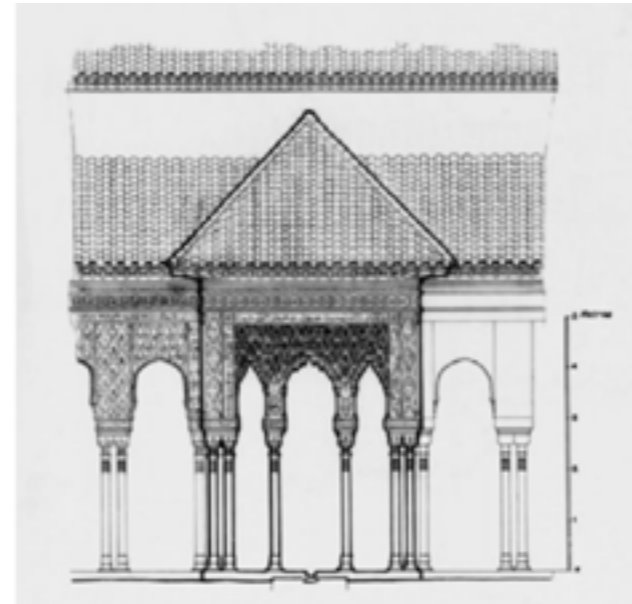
Estudio de la cubierta del pabellón de levante con alero único y fuerte pendiente.
